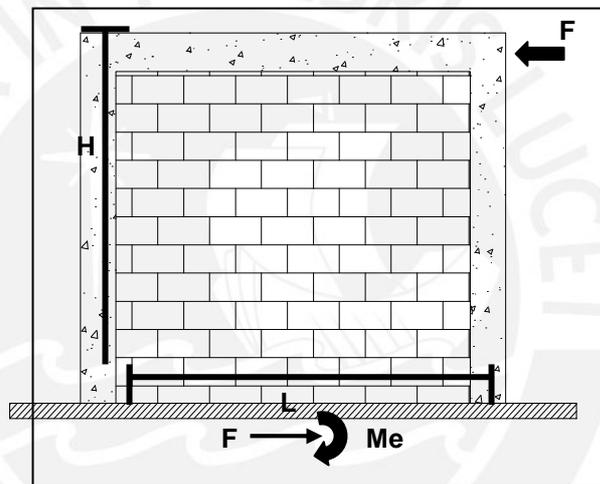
Fuerza cortante y momento en muro de vivienda de un piso.
